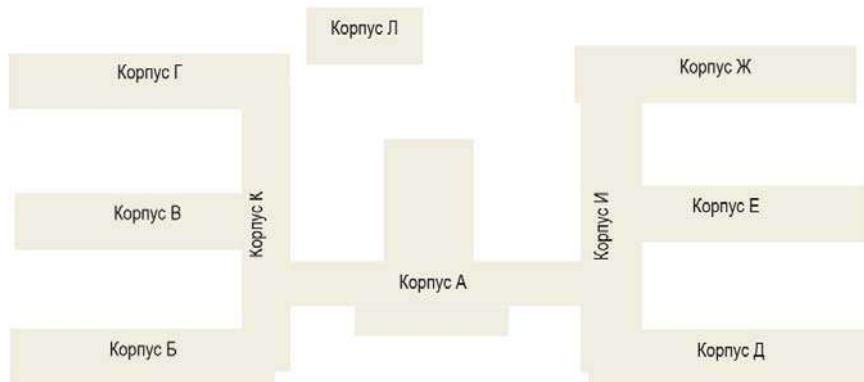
Схематичное расположение корпусов типового учебного заведения
